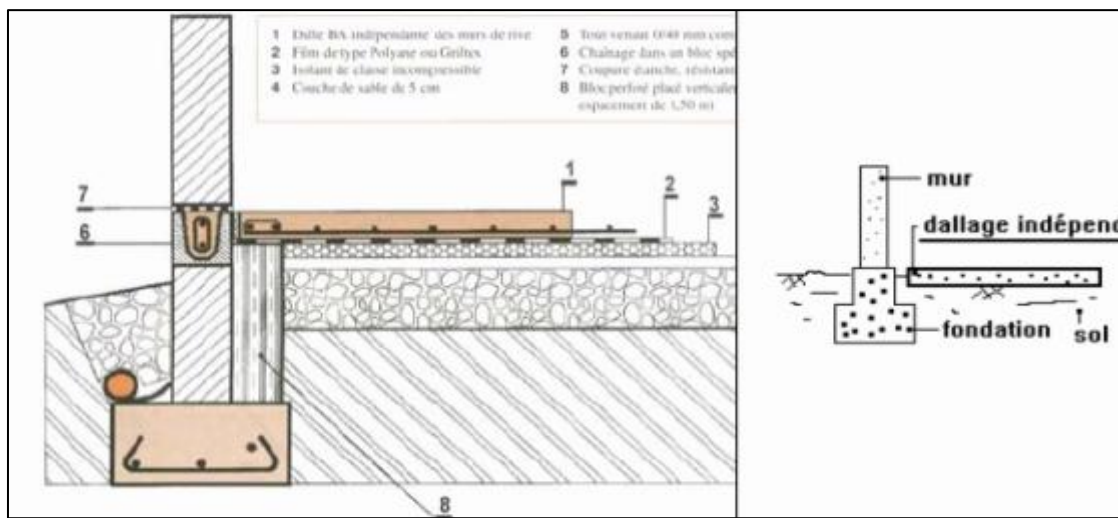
Dallage en béton armé indépendant du mur de rive
